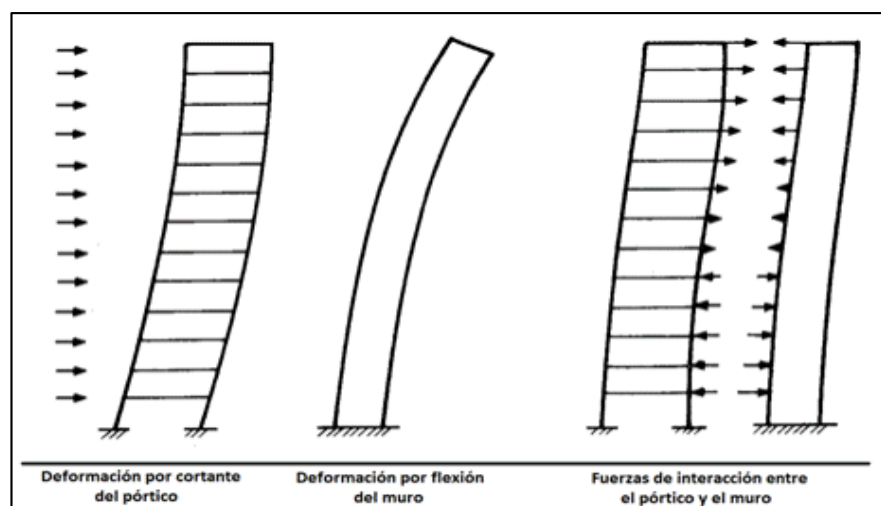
Interacción de esfuerzos entre muros y pórticos
